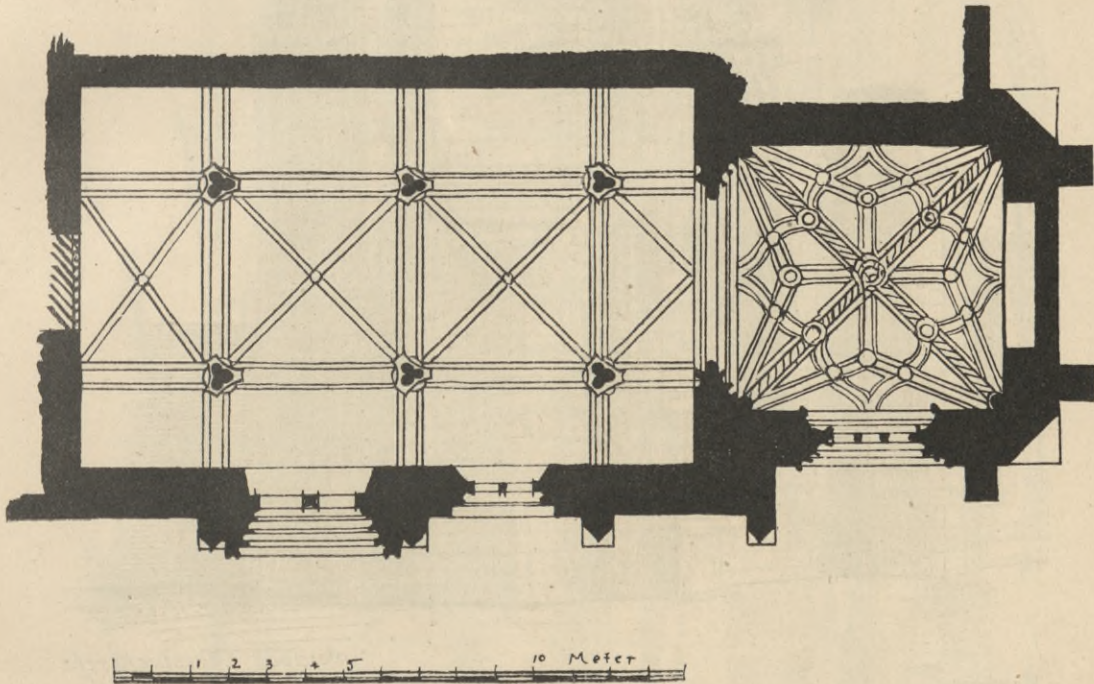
Grundriss der Christuskirche zu Setubal.
